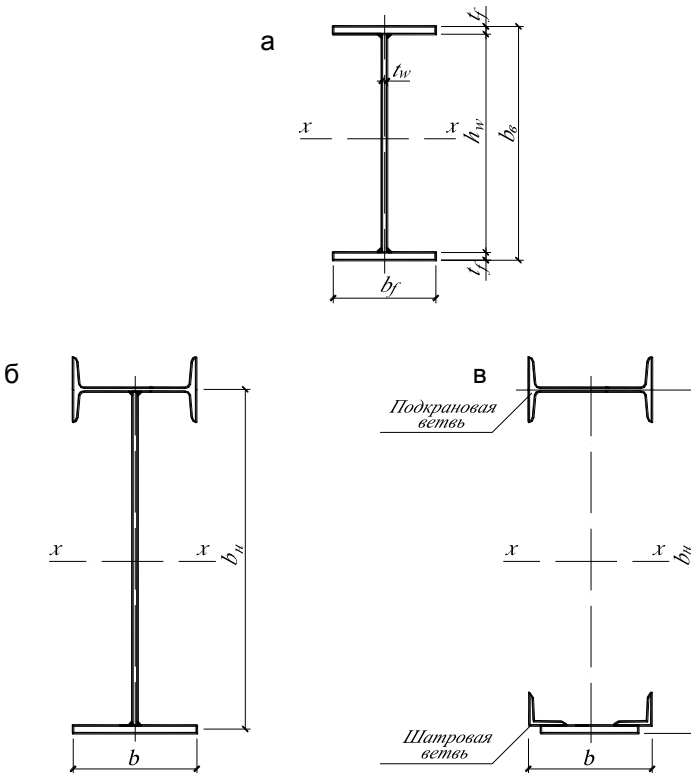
Поперечные сечения колонн крайнего ряда:
